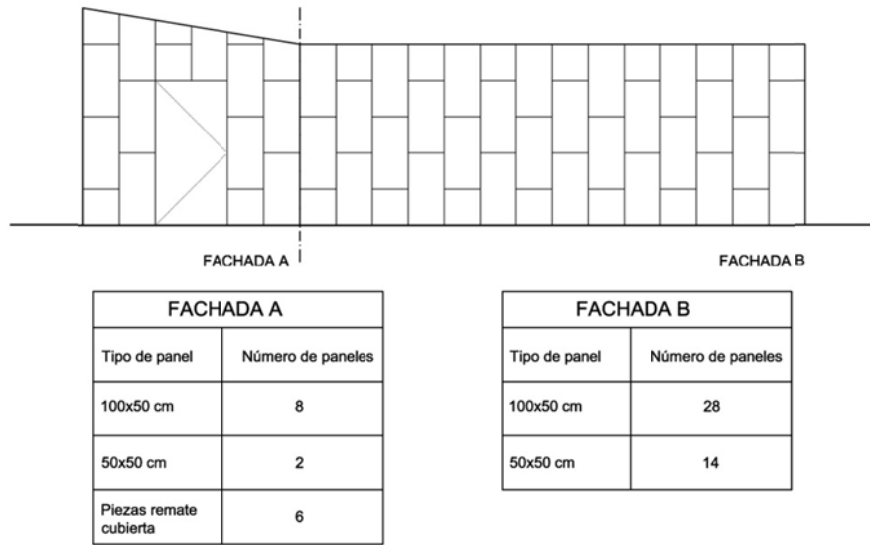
Esquema de reparto de paneles en fachada. (Fuente: Elaboración propia).
